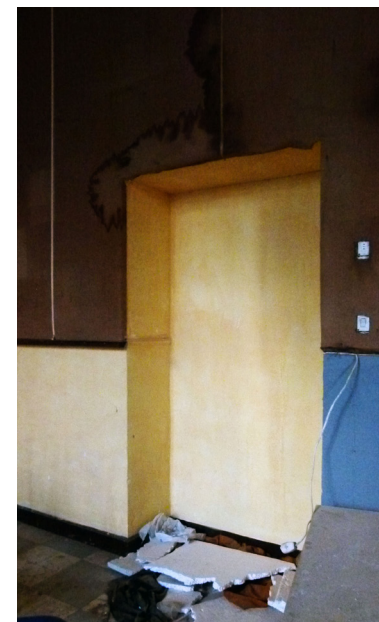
, Puerta de acceso cegada en aula de planta baja
